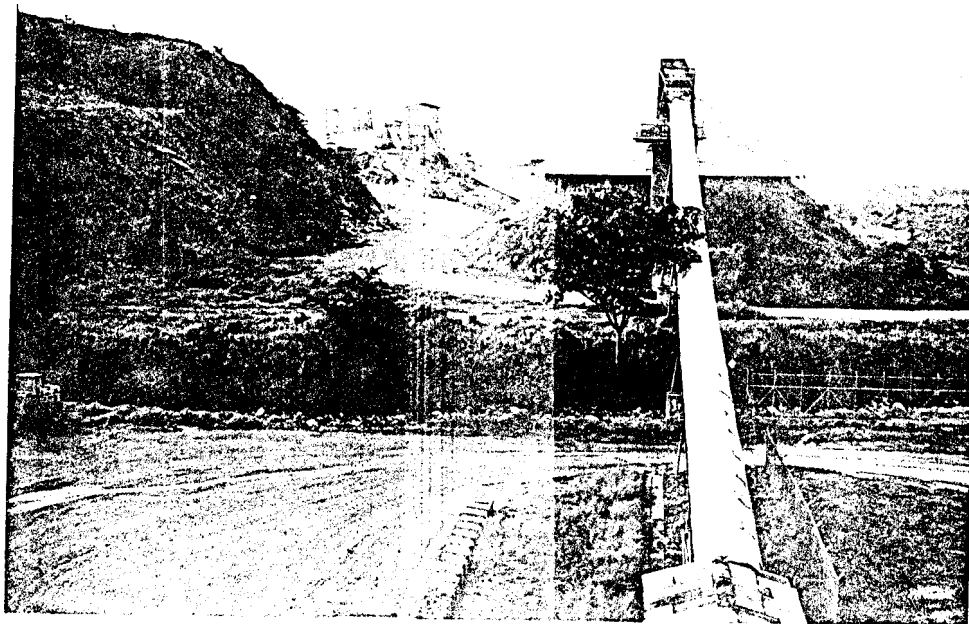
CUBIERTA PROTECTORA DE LAS BANDAS Y CIRCO DE ALMACENAMIENTO DEL MATERIAL TRITURADO Y VIAS NO PAVIMENTADAS
